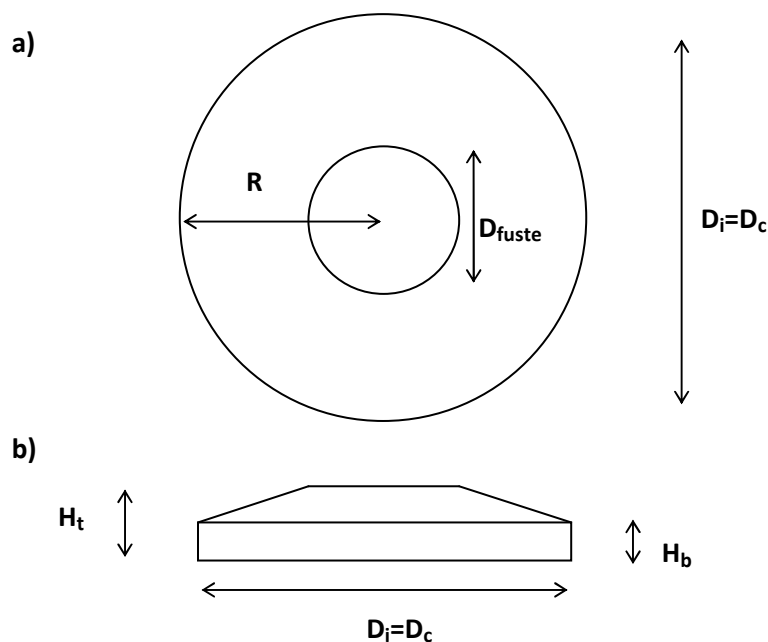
Zapata circular: a) vista en planta, b) vista en alzado.
